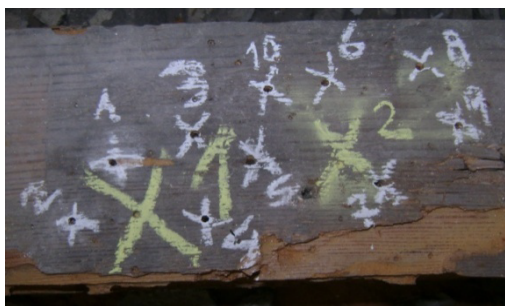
Localização dos ensaios realizados na Viga 8 do pavimento (Canto superior)
